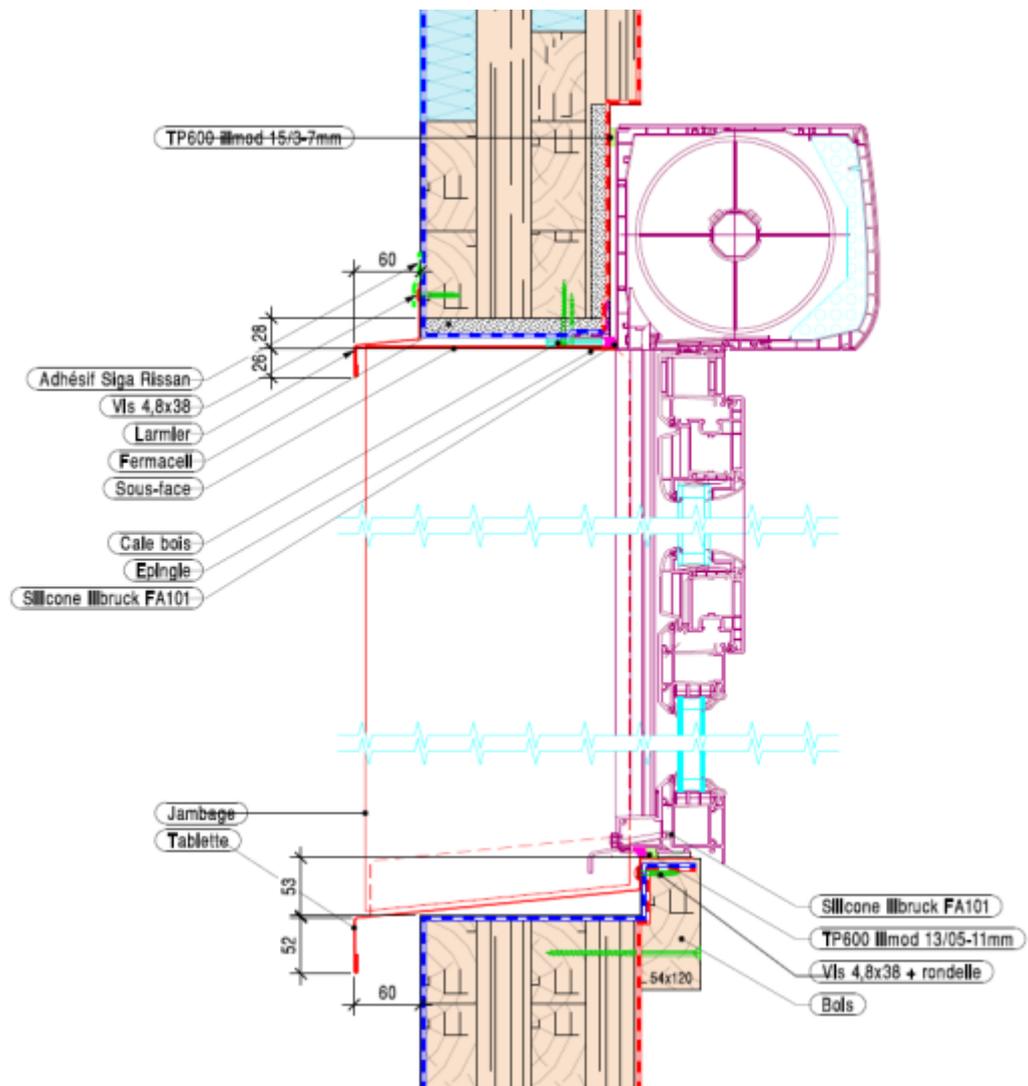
Essai AEV Menuiserie en tunnel / coupe verticale
